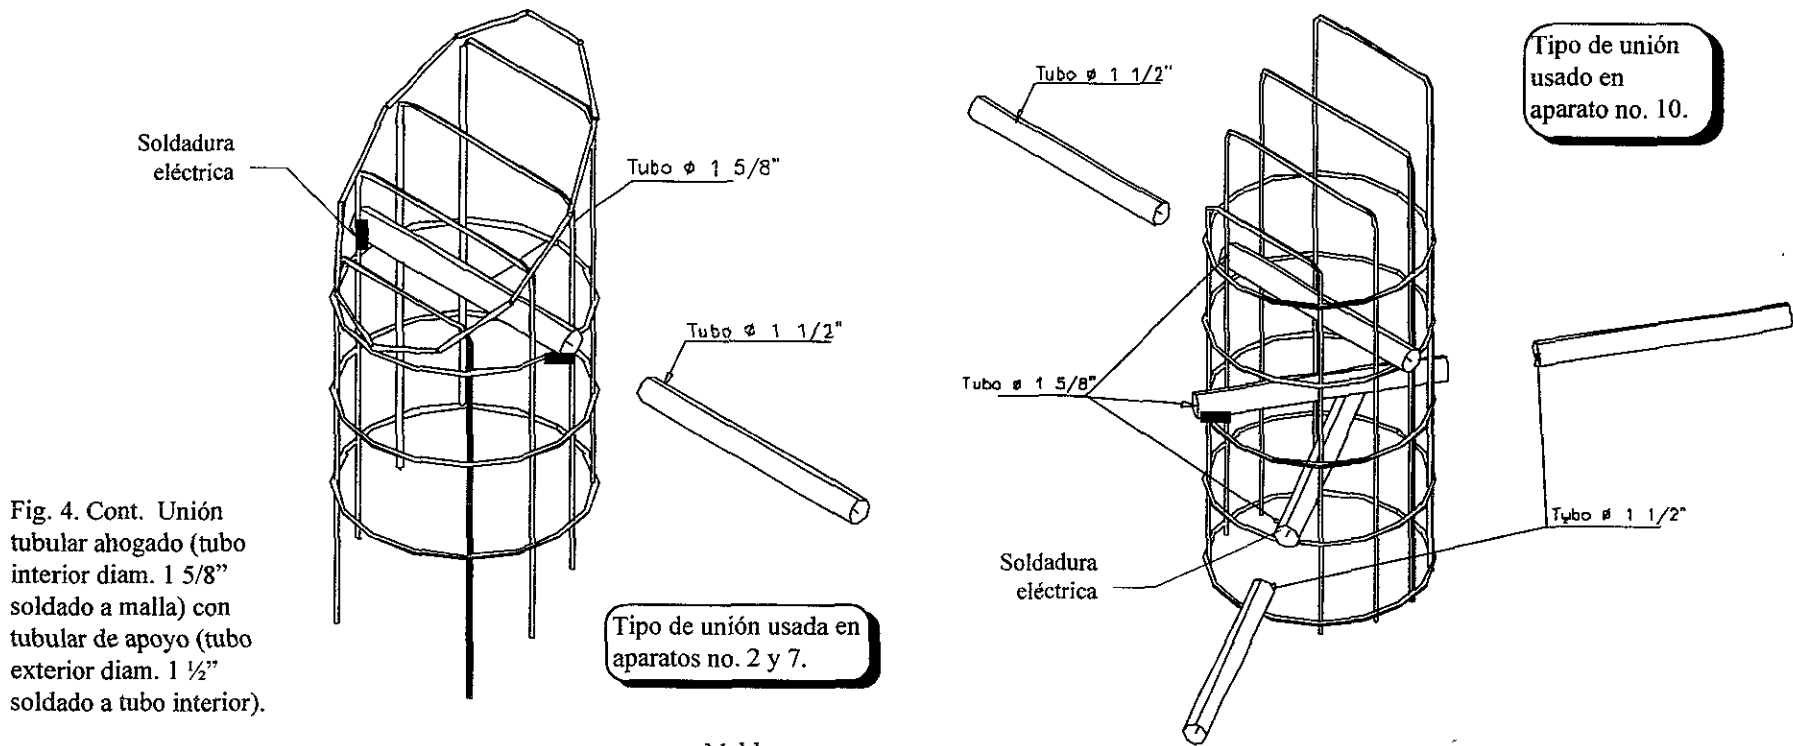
Cont. Unión tubular ahogado (tubo interior diam. 1 5/8" soldado a malla) con tubular de apoyo (tubo exterior diam. 1 1/2" soldado a tubo interior).
